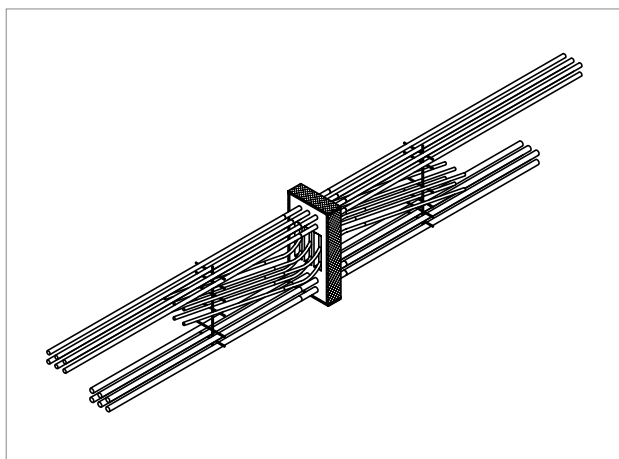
Schöck Isokorf® T type B-M5-V1 in hoogte H400: Buitenaanzicht
